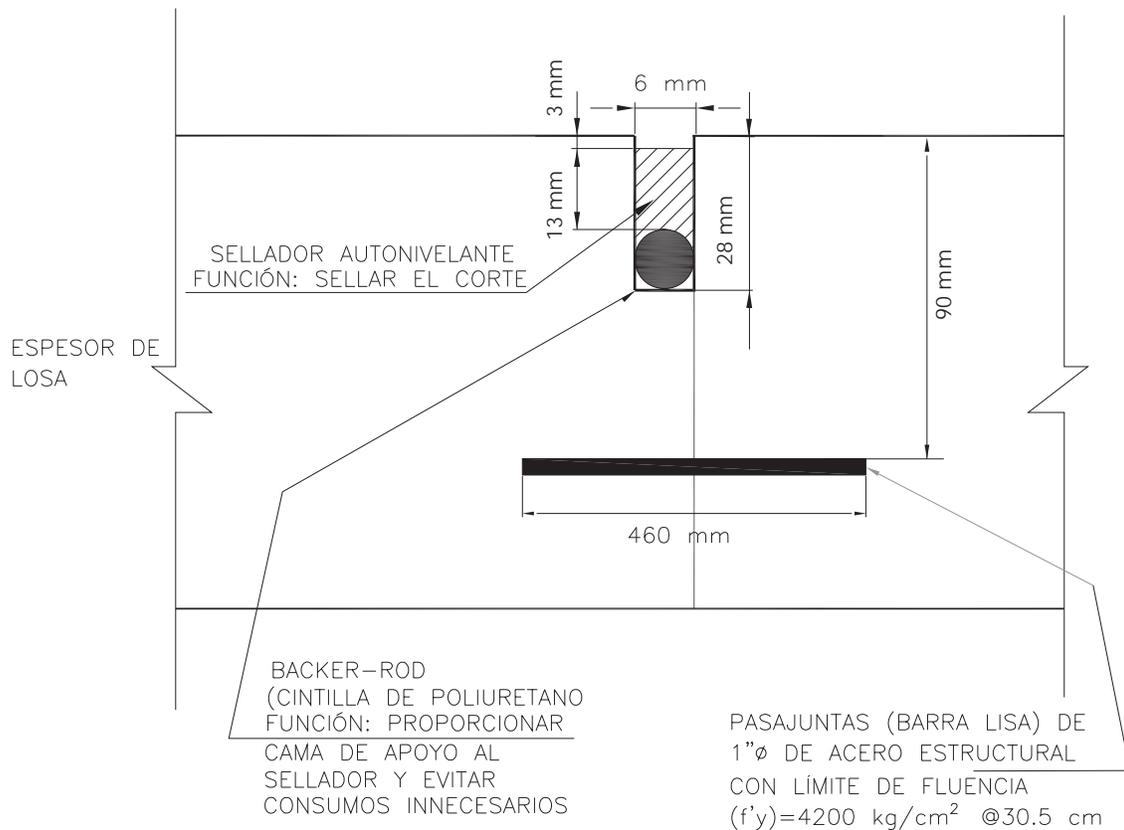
Junta longitudinal de construcción tomada del plano C – 09a.
